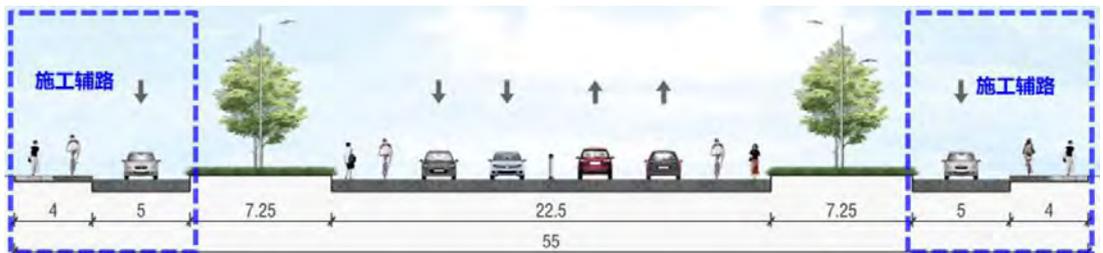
头道桥~金湾路第一阶段施工断面示意图
